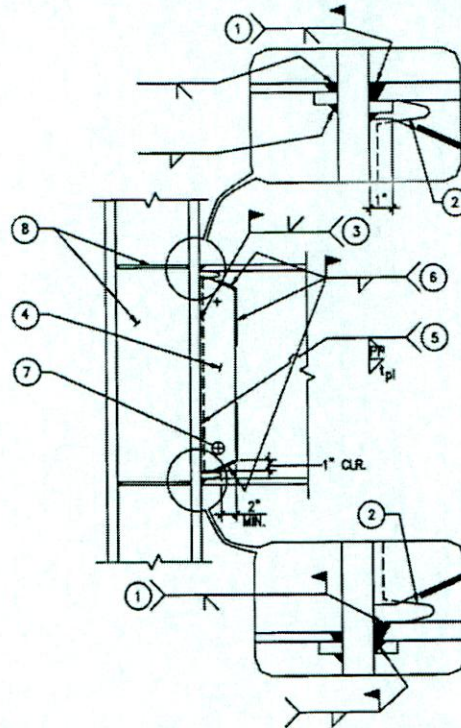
Conexión Ala no reforzada – Alma Soldada
